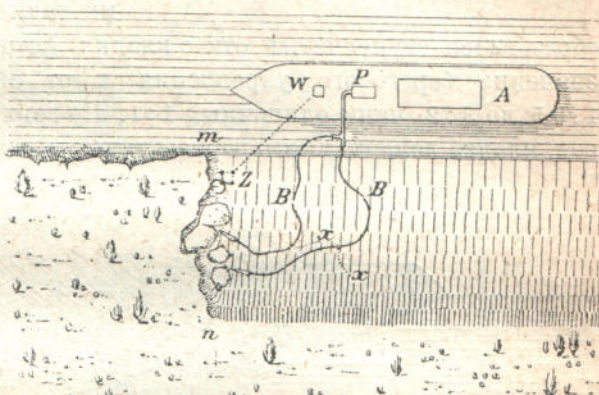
Планирование откоса берега помощью смыва струей воды из насоса.
